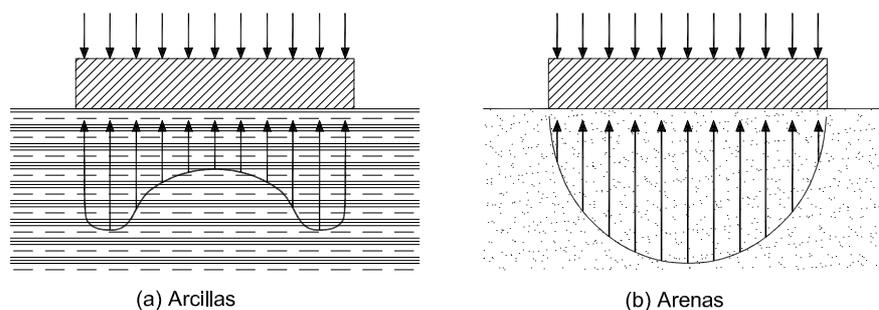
Distribución de presiones en zapatas rígidas sobre arcillas y arenas
